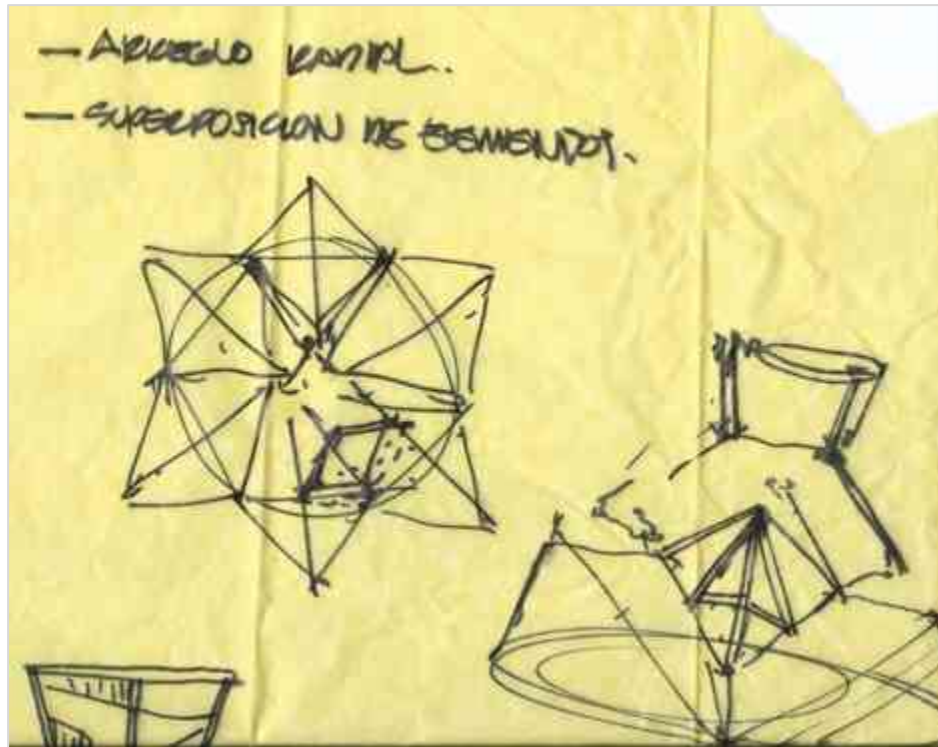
Conceptualización de cubierta de Restaurante Bar Zamá.
